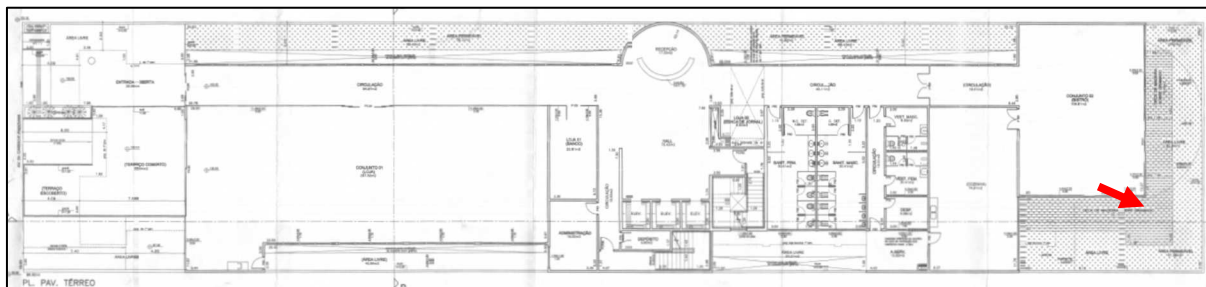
Hall de elevadores do pavimento térreo.
